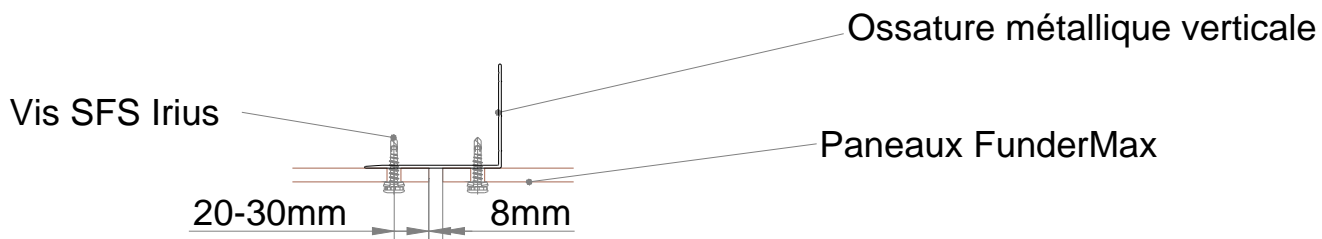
Joint vertical à la jonction de panneaux en bardage rapporté ventilé
